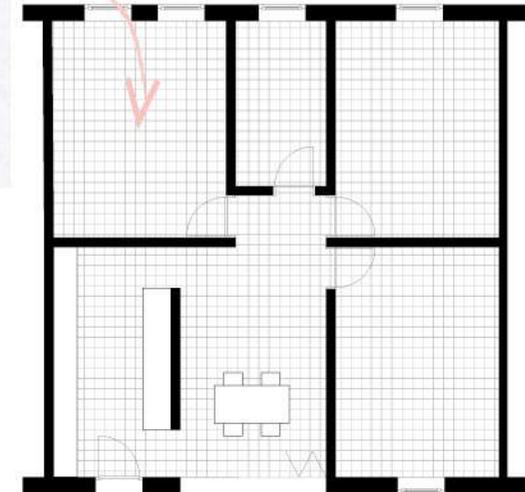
Grundrissveränderung durch Umbau
